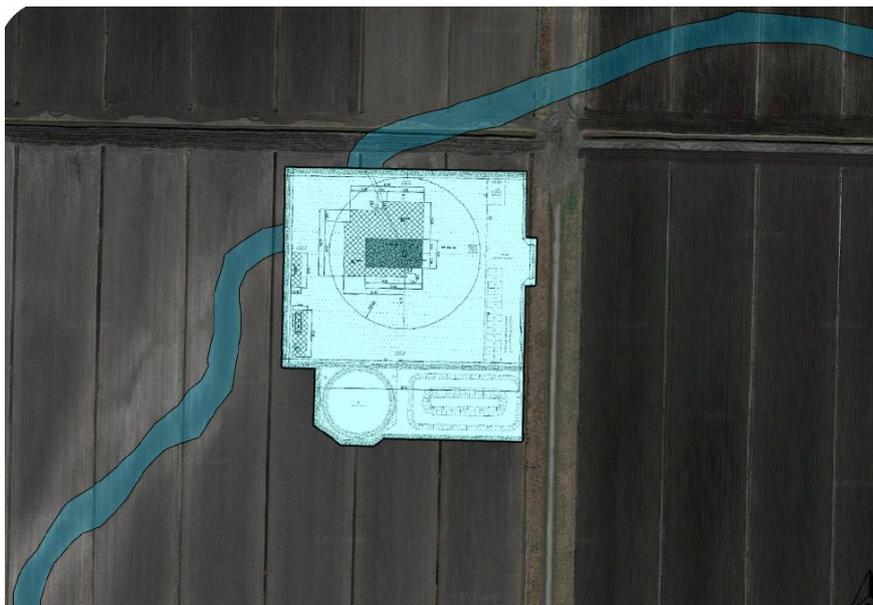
s: Localizzazione Paleoalveo rispetto alla Postazione del Pozzo Trava-2 dir
